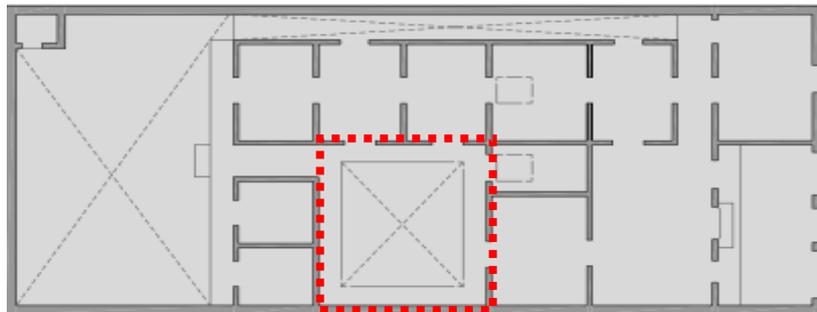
Rancho típico que cuenta con un patio, según las dimensiones de la abertura superior este llega a tener columnas que lo convierte en una galería perimetral.
